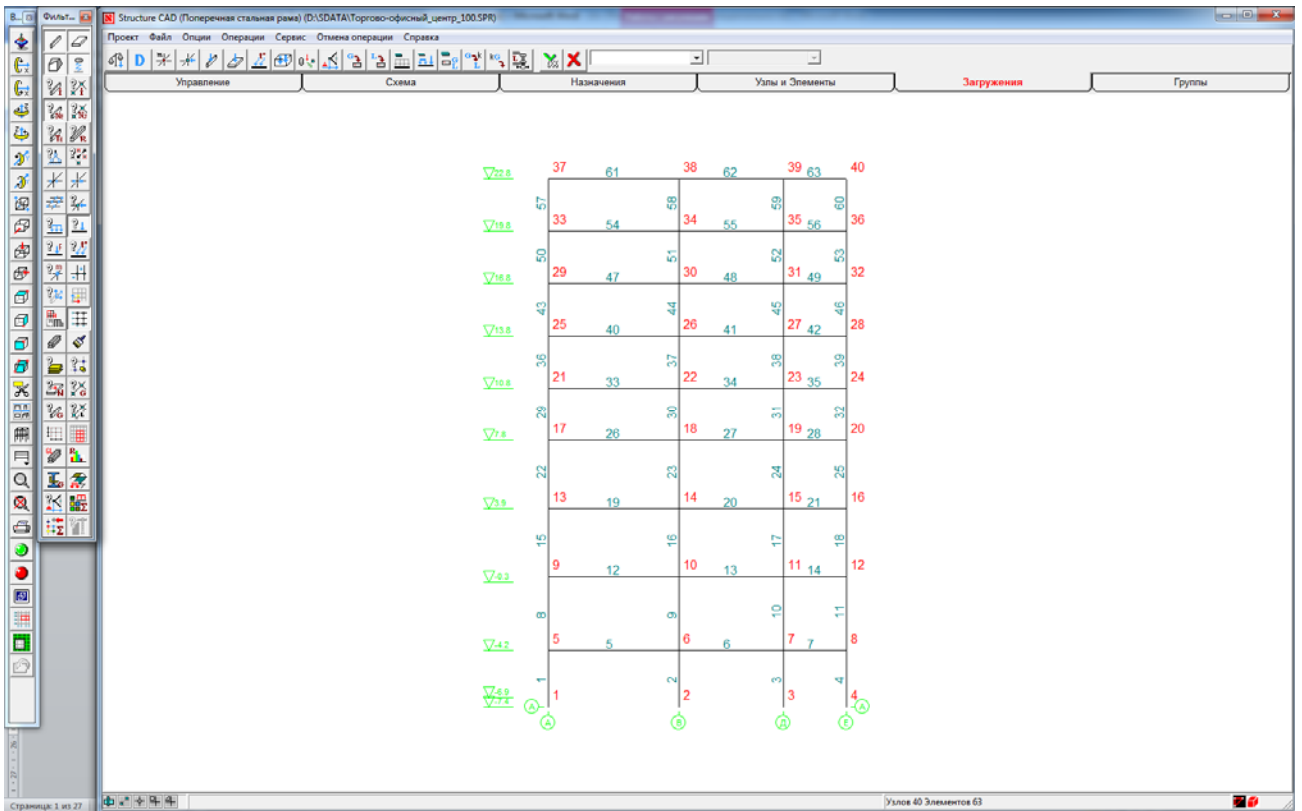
Расчетная схема здания с номерами узлов и конечных элементов.
